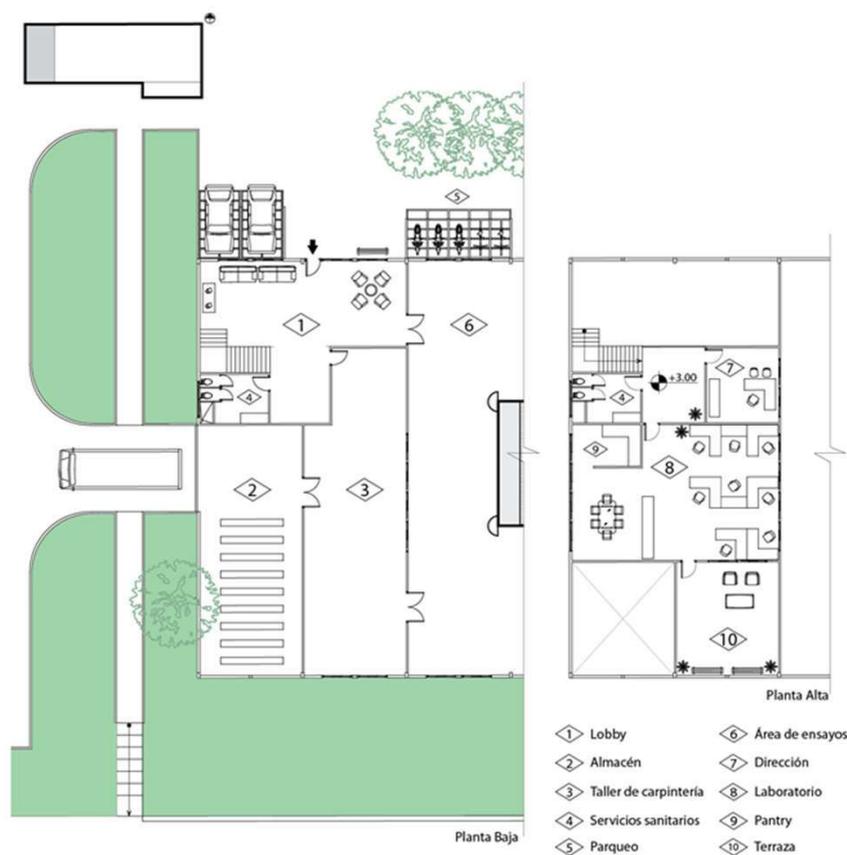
Distribución en planta del proyecto de nave para el túnel de viento. Área de investigación.
